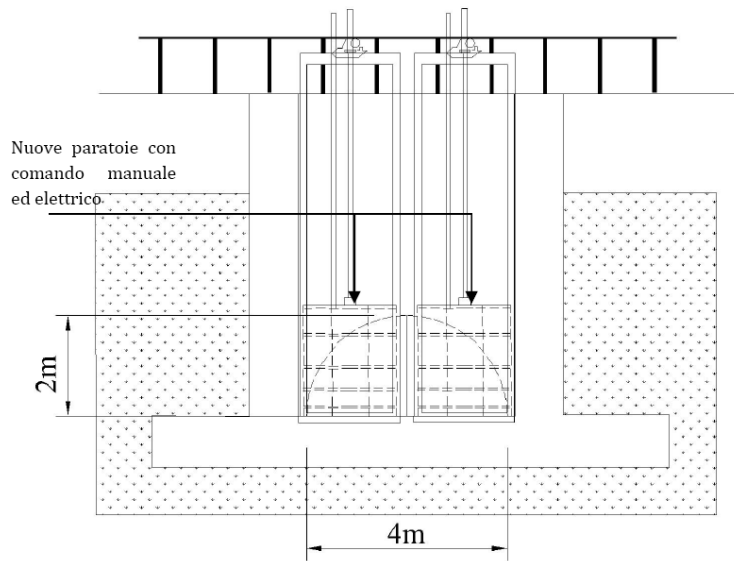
Prospetto delle nuove paratoie del Cavo Diotti
